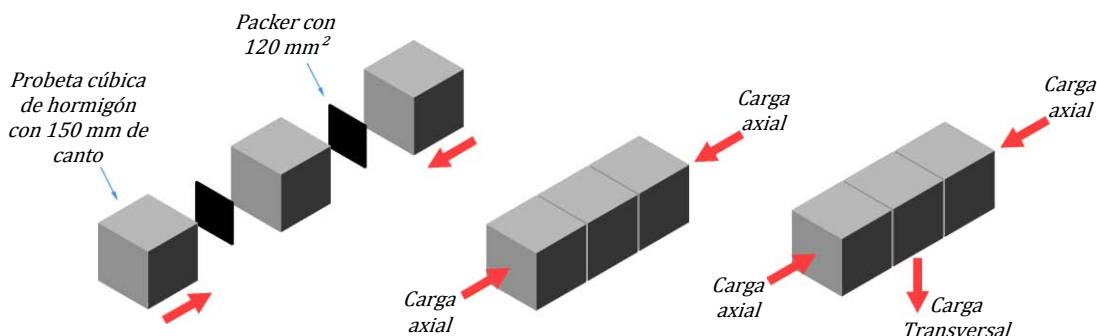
Configuración y procedimiento de ensayo propuesto por de Wall
